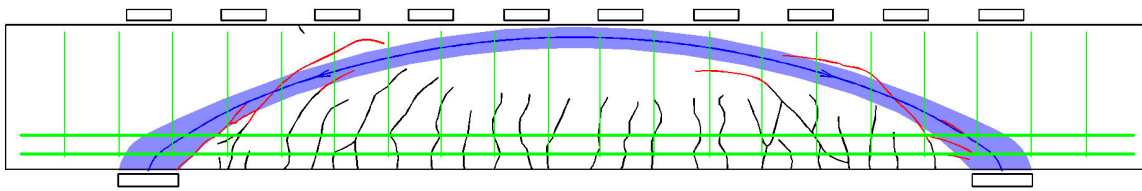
Balken B 4 mit überlagerter Druckparabel und zugehörigen Rissen
